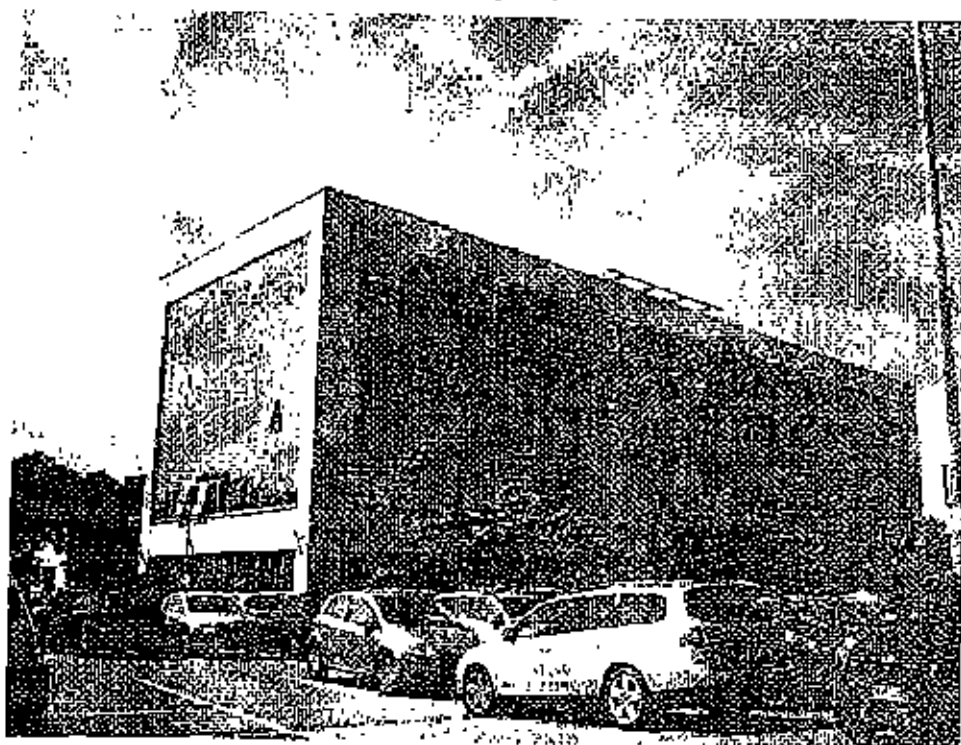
Prospetto principale dell'edificio verso l'area a parcheggio.
